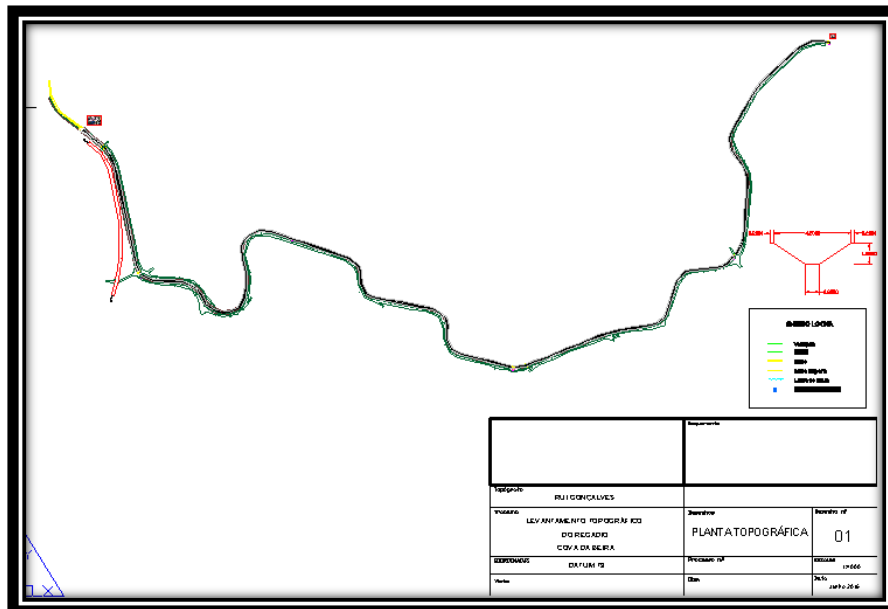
Planta topográfica de uma extensão da zona de Regadio da Cova da Beira e perfil transversal do canal
